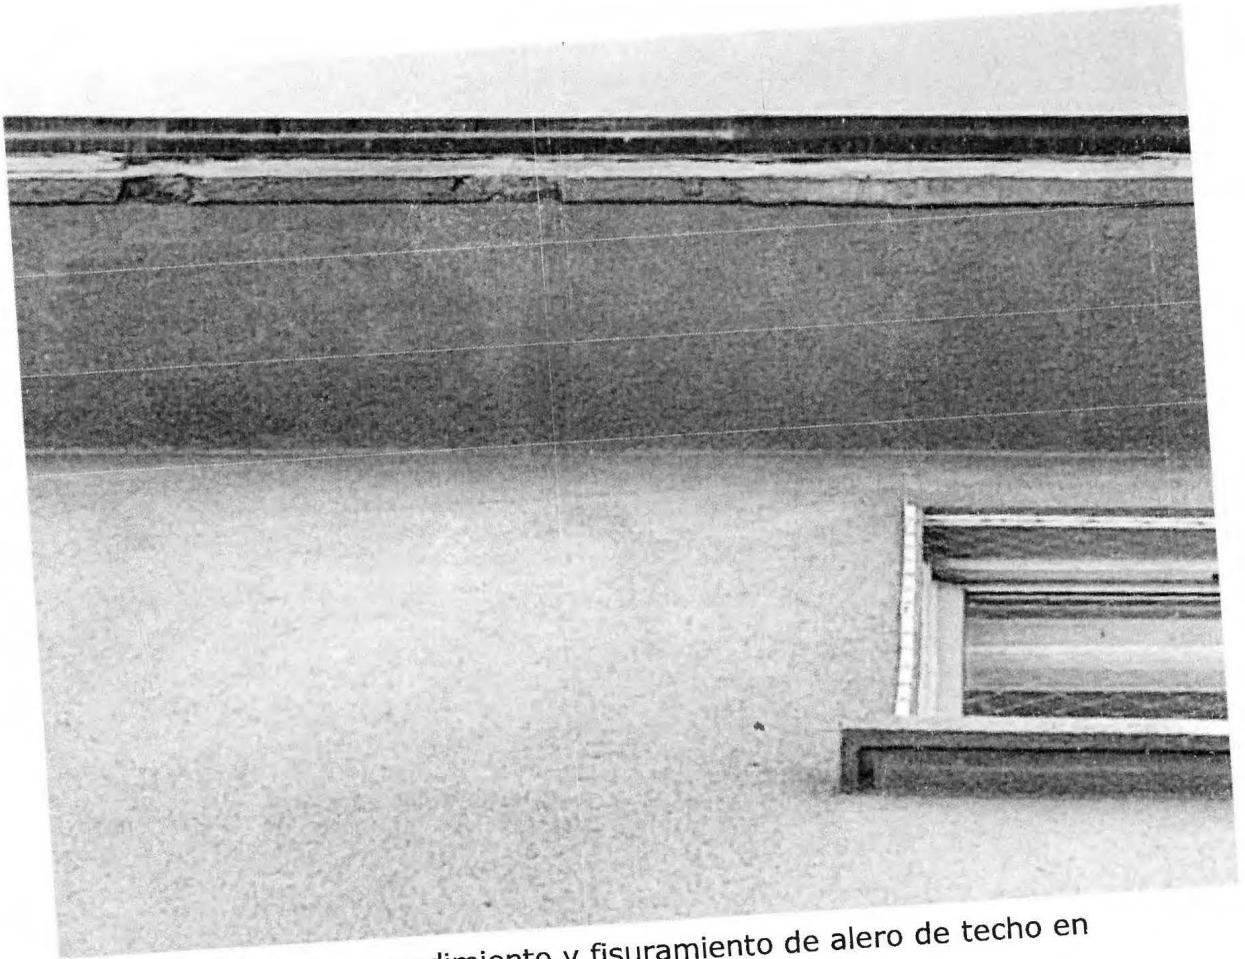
Desprendimiento y fisuramiento de alero de techo en fachada norte.
